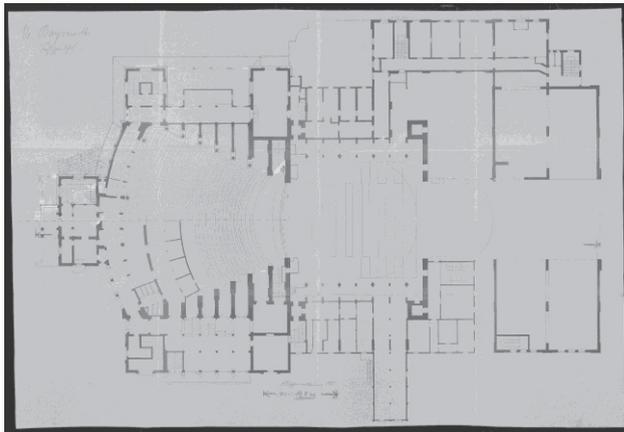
Planta baixa da Casa de Festivais de Bayreuth.
